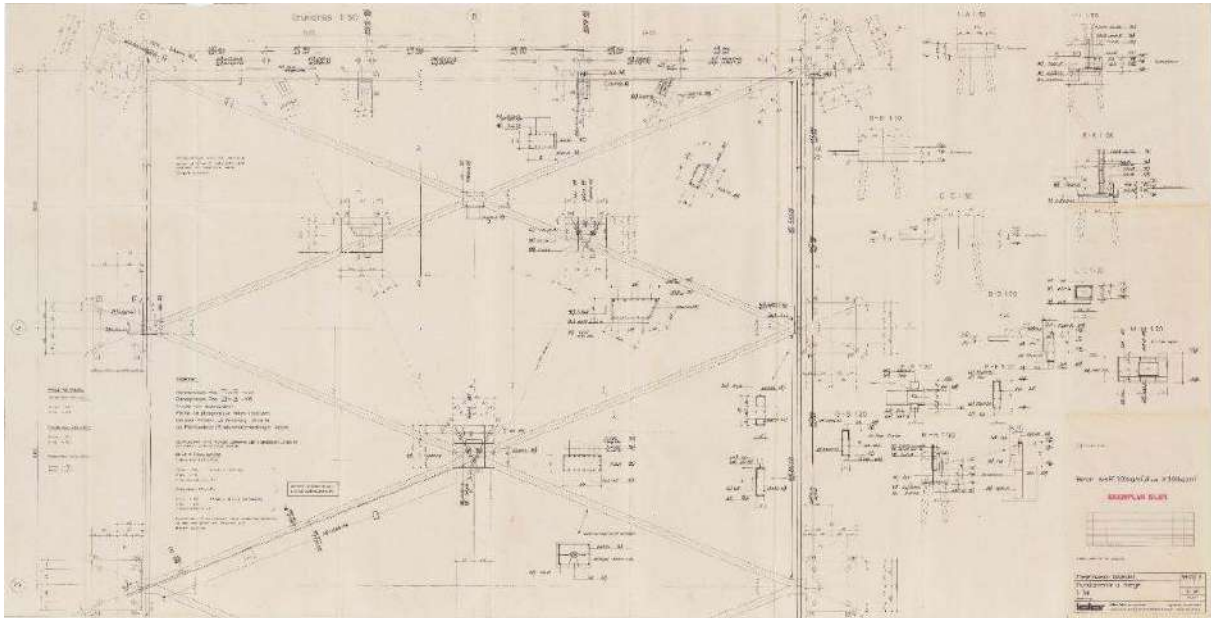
Pianta delle fondazioni (gta Archiv/archivio Isler rif. 217_0BSB423.59).
